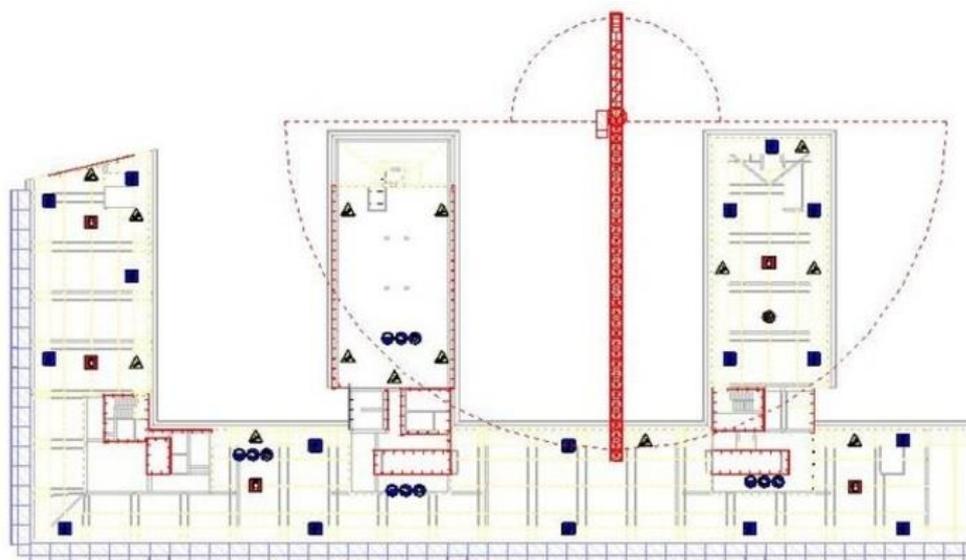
Vista planimetrica del modello BIM per una fase di demolizione di un edificio
